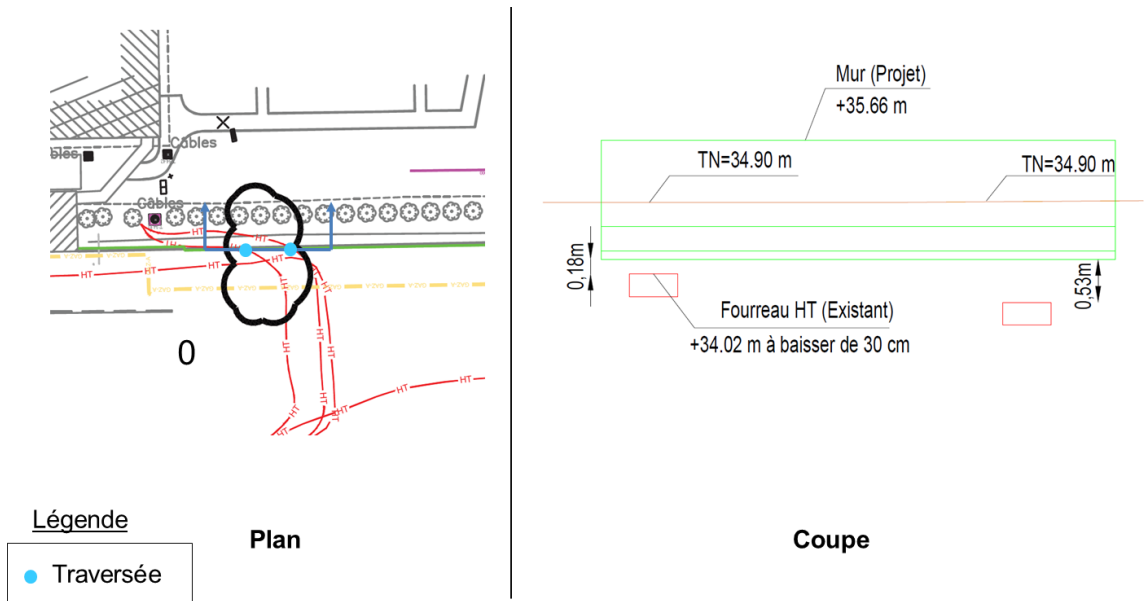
Mur traversant les fourreaux électriques haute tension
